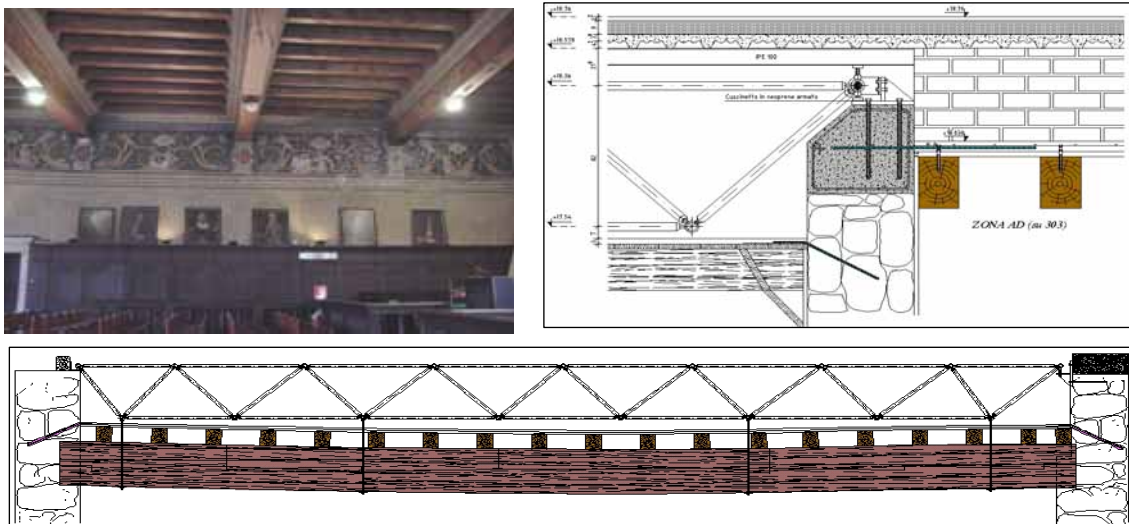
a, b, c. La struttura reticolare spaziale al di sopra del solaio
